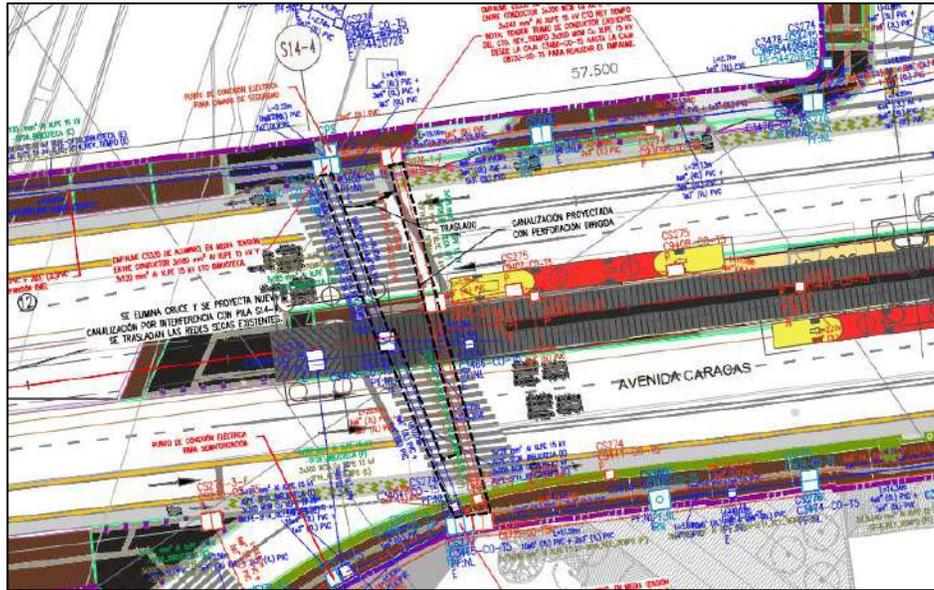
Plano de localización general de la red ENEL-5-11. PILAS S14-4
